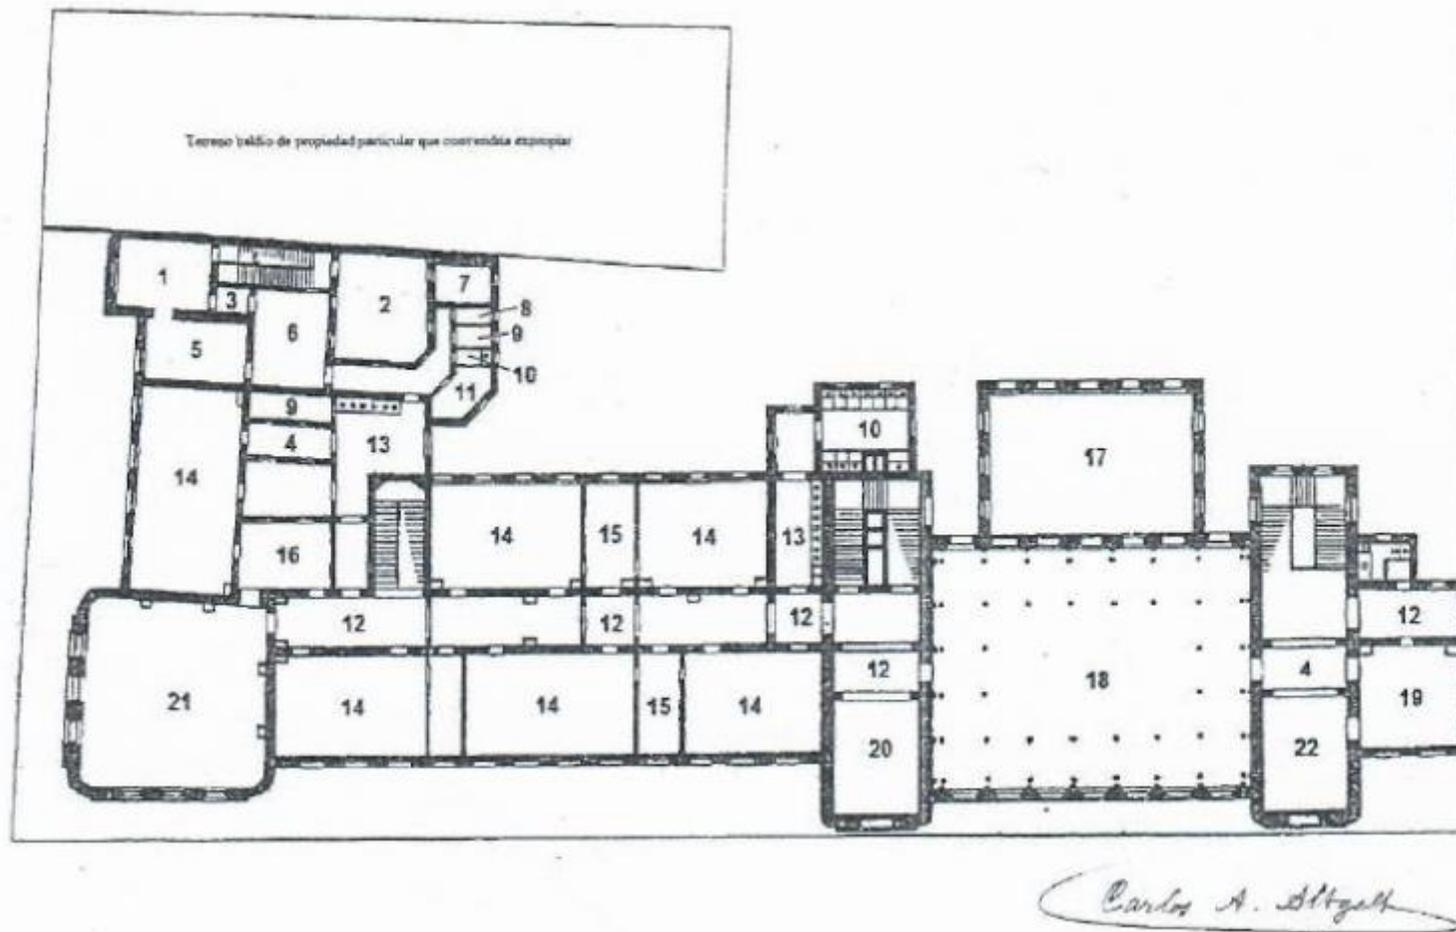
Planta de arquitectura. Primera etapa [Planta baja ampliada]
